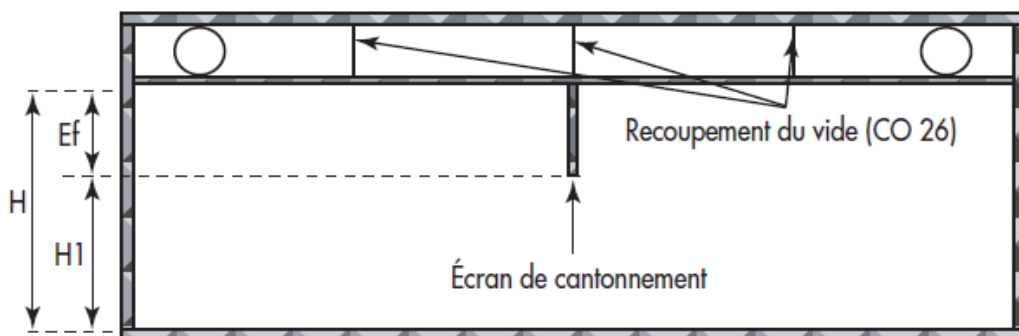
Plafond suspendu ne comportant pas 50 % de passage libre [1].
